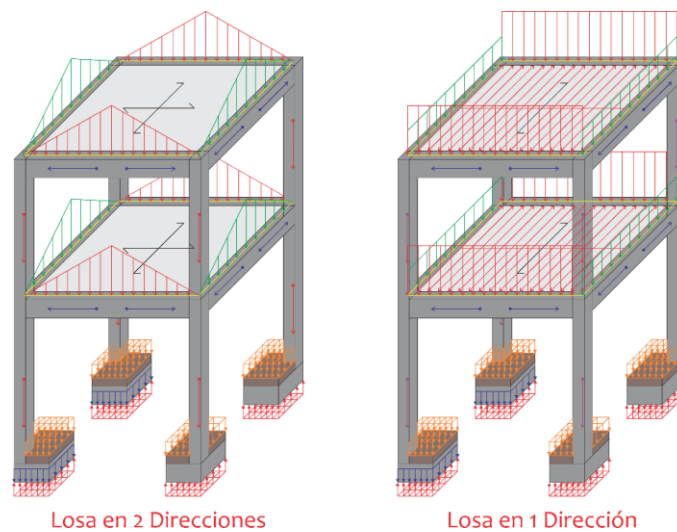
Camino de Cargas para el Sistema Estructural Aporticado.
